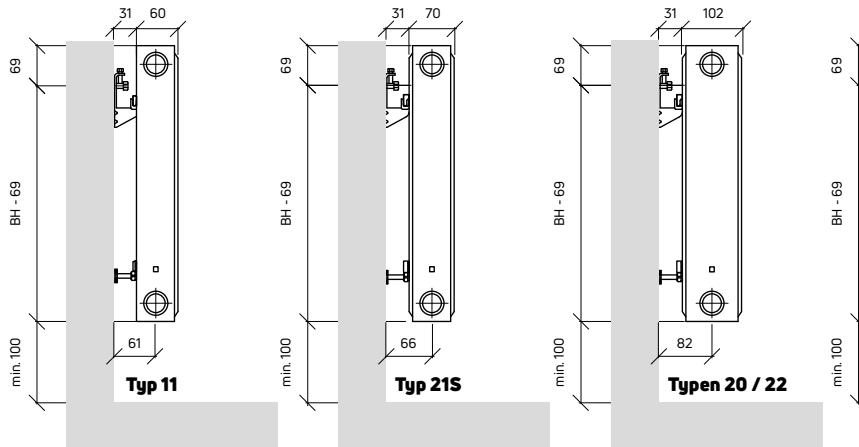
Montagemaße für Compact mit Befestigungslaschen
